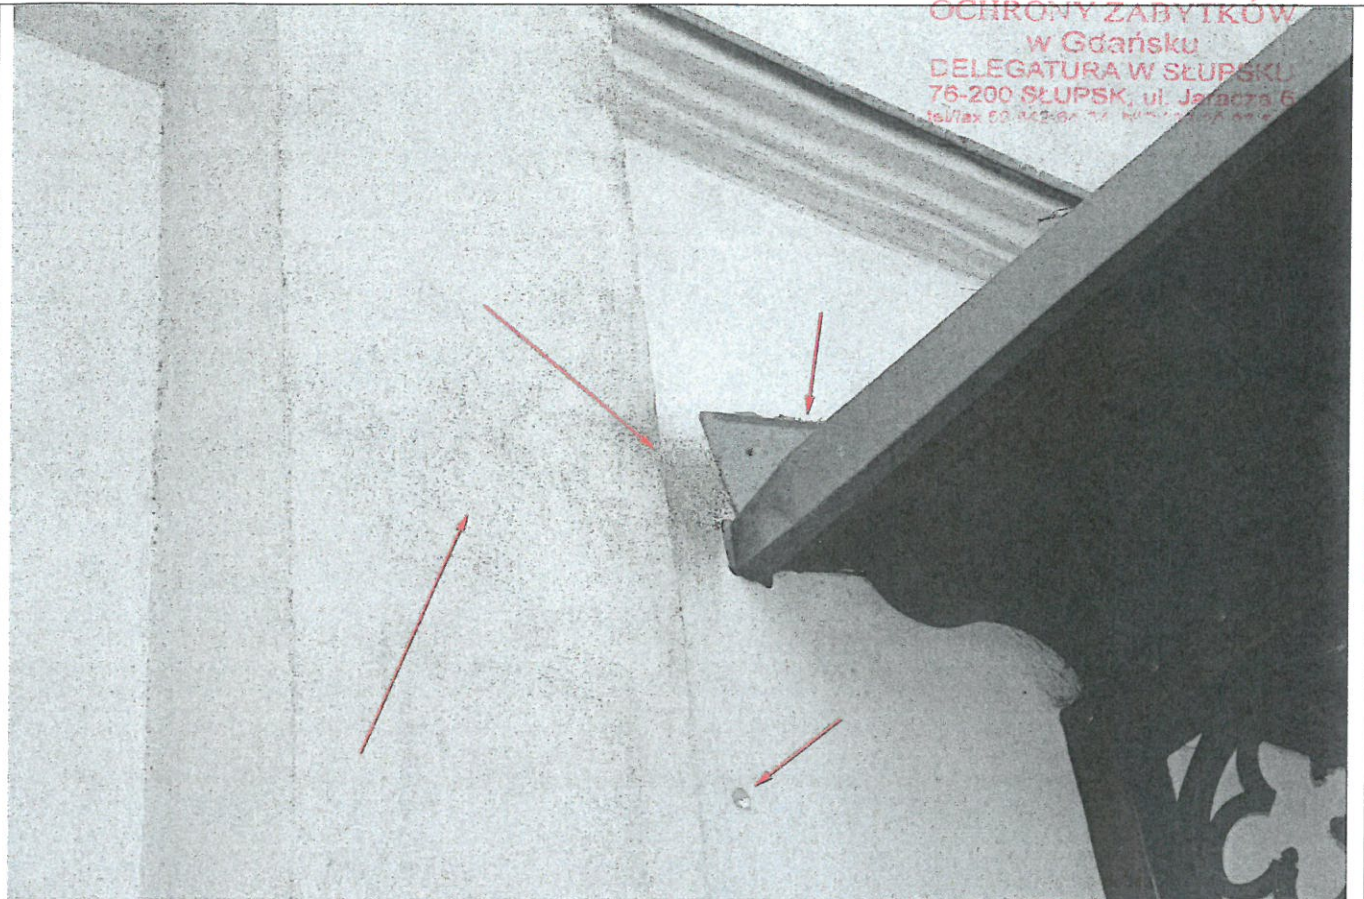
Uszkodzenia tynku przy zbiorniczku – elewacja frontowa
